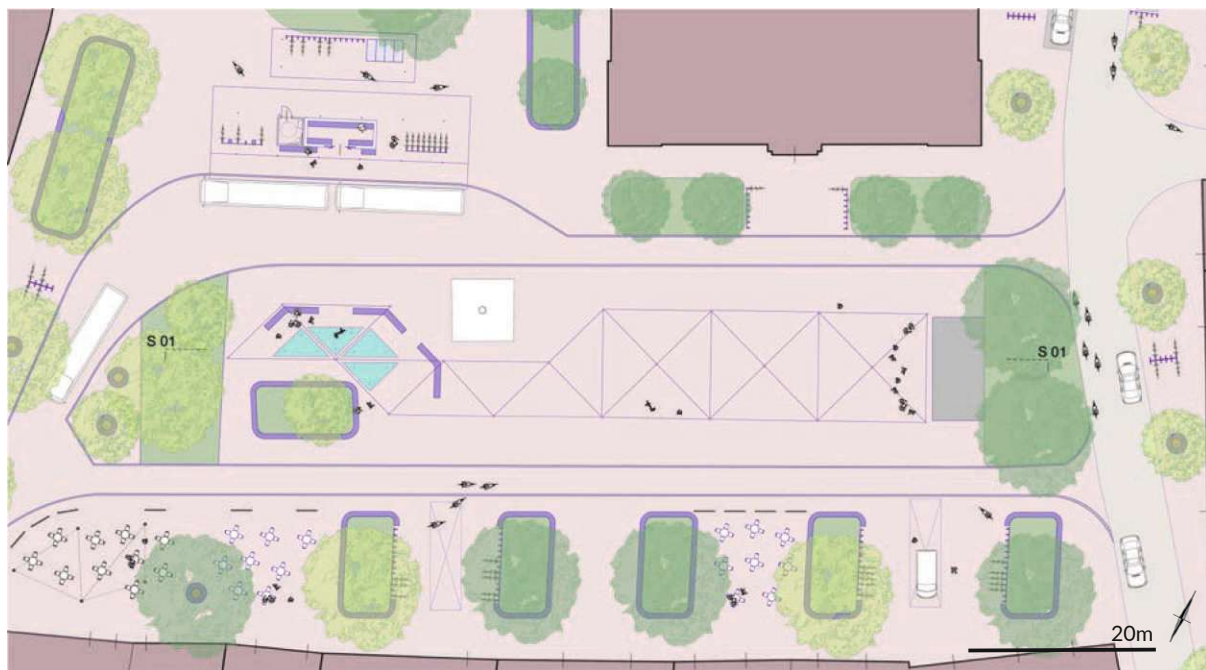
Grundriss Hauptplatz, eigene Darstellung
